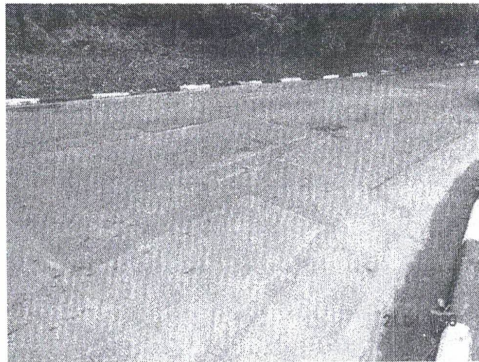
Remendo: panela preenchida com uma ou mais camadas de pavimento na operação denominada “Tapa Buraco”
